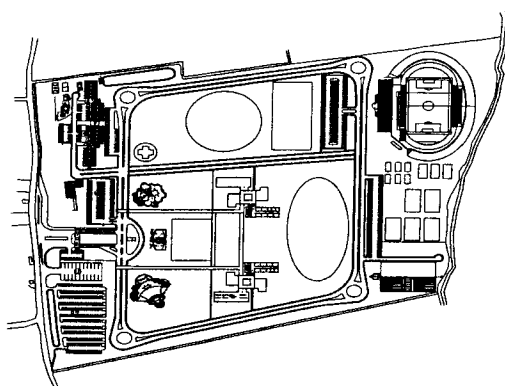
Plan Masa del Nuevo Campus Politécnico [3]
